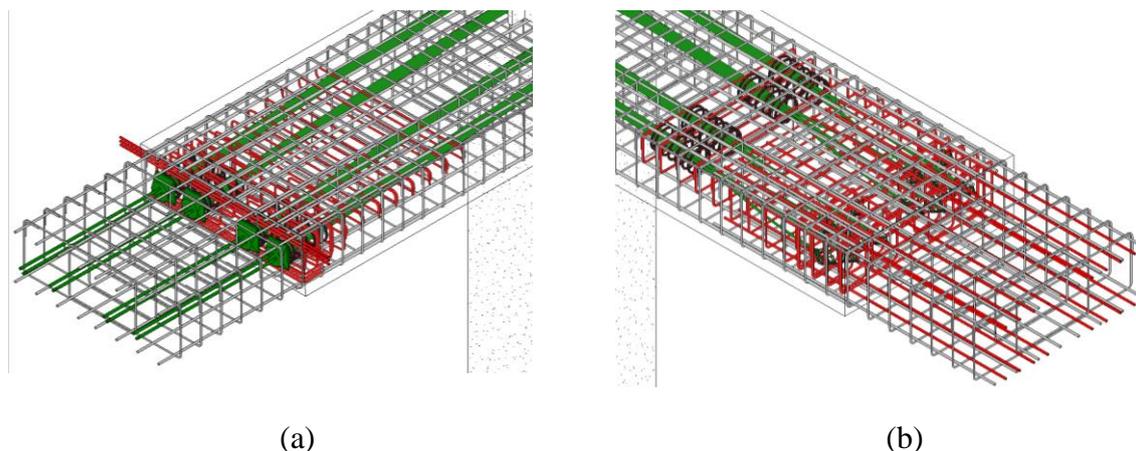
Modelação do objeto BIM –nichos: (a) vista com armaduras de reforço; (b) vista após a aplicação do pré-esforço. Armaduras de reforço a vermelho e ordinárias a cinzento.
